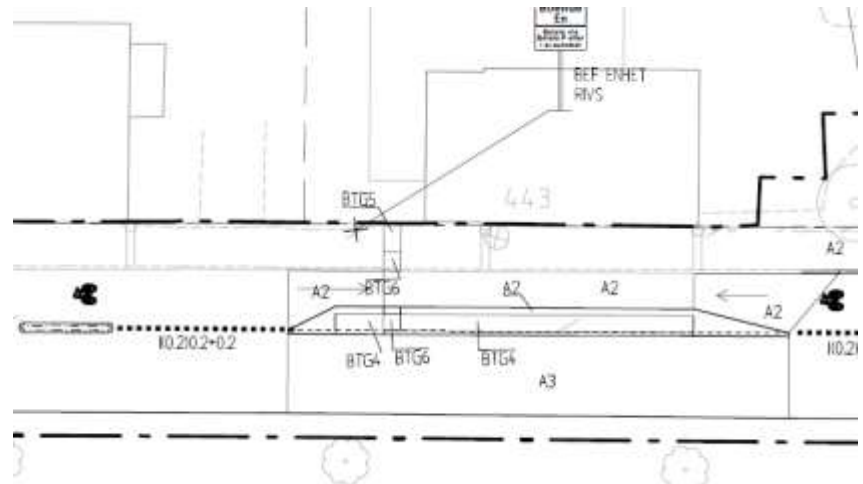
Sektion södra sidan, mellan Handelsvägen och Stockholmsvägen
